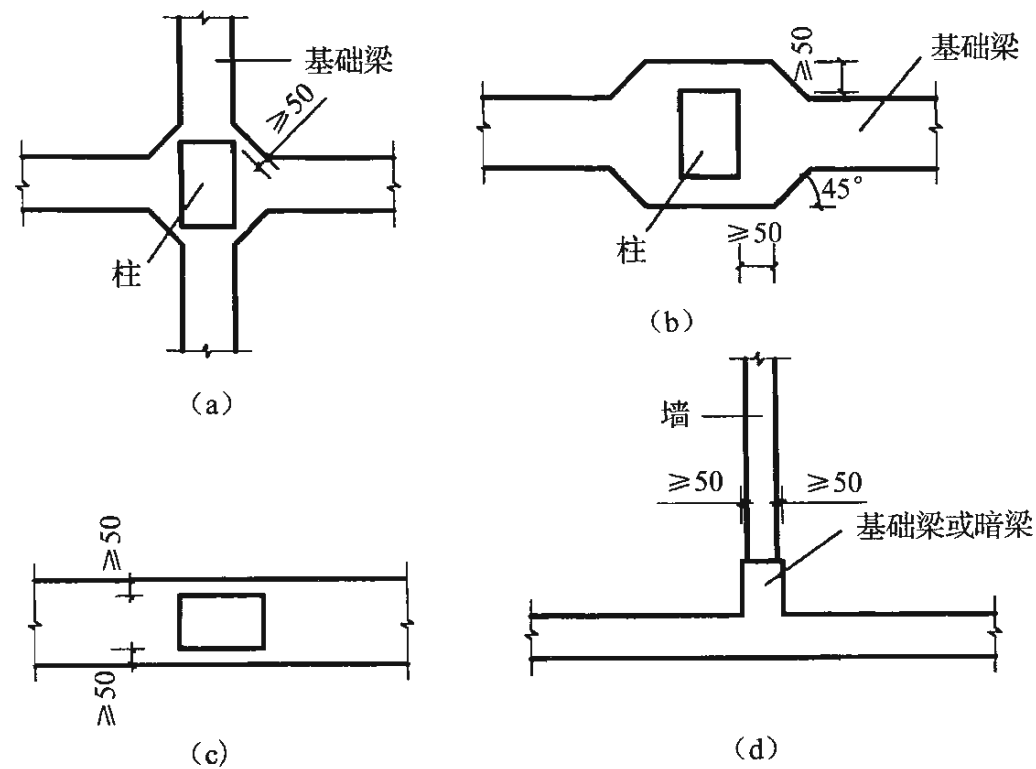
地下室底层柱或剪力墙与基础梁连接的构造要求
